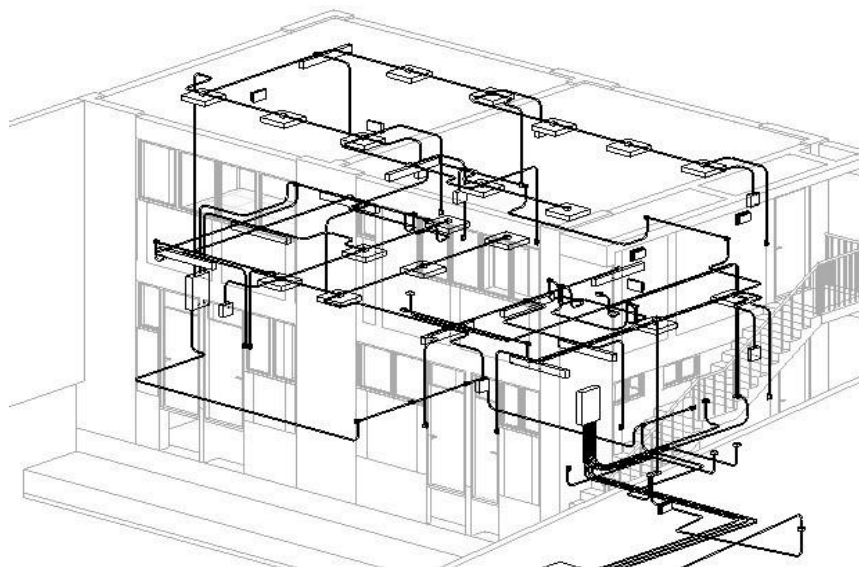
Modelado de Inst. Eléctrica del Pabellón N°02 – vista en 3D
